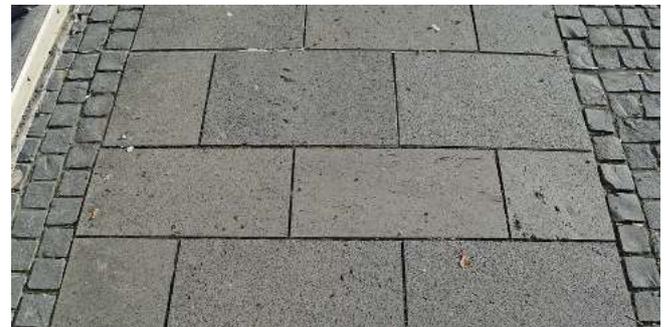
Laufband mit Basaltplatten in gebundener Ausführung
